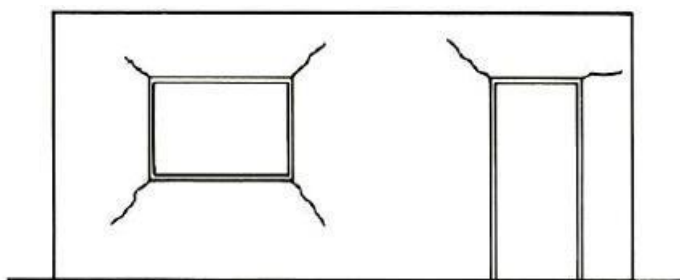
Fissuras verticais causadas pela sobrecarga de carregamento
